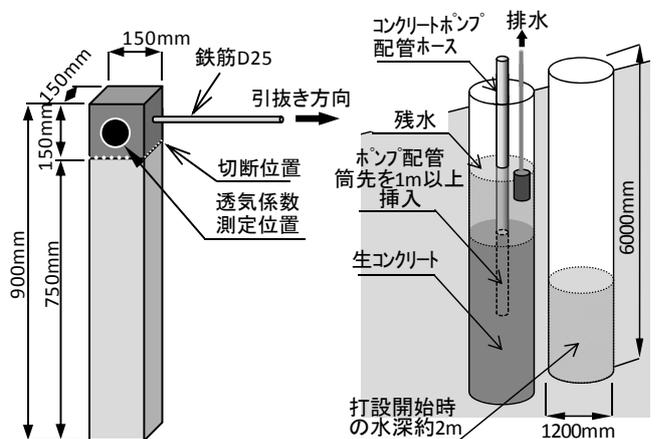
付着強度試験用供試体 図-2 実大部材実験実施状況
